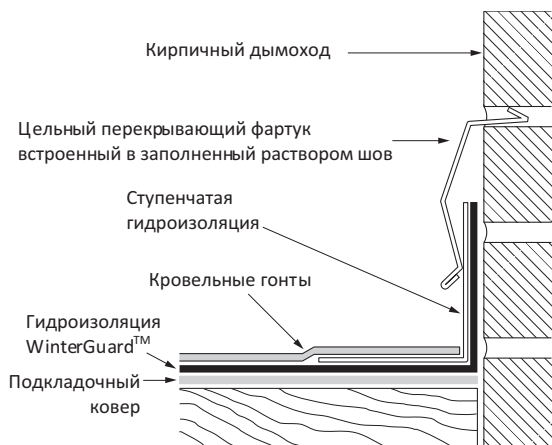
Проходящий через стену металлический перекрывающий фартук, встроены в каменную кладку.
